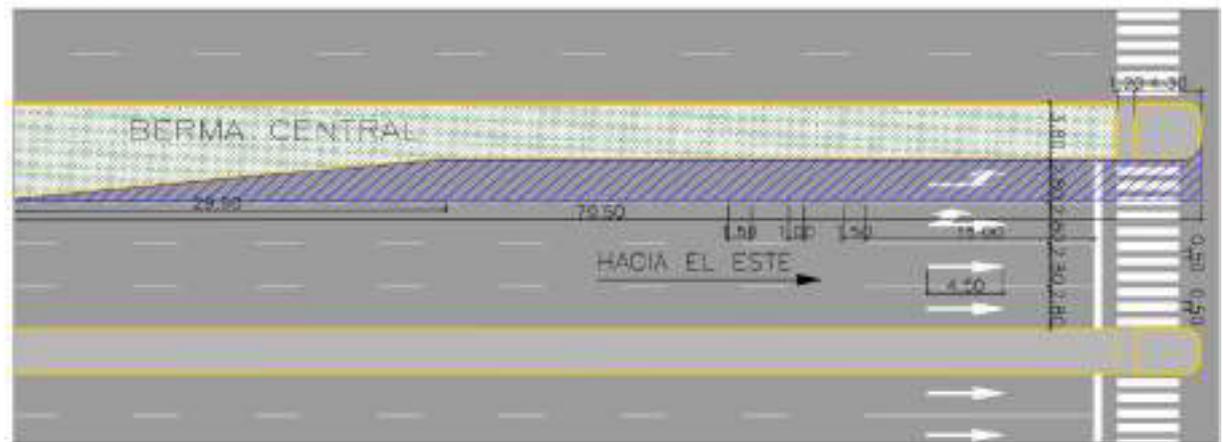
Detalles Carril giro izq. Propuesta – Av. Primavera O – E
